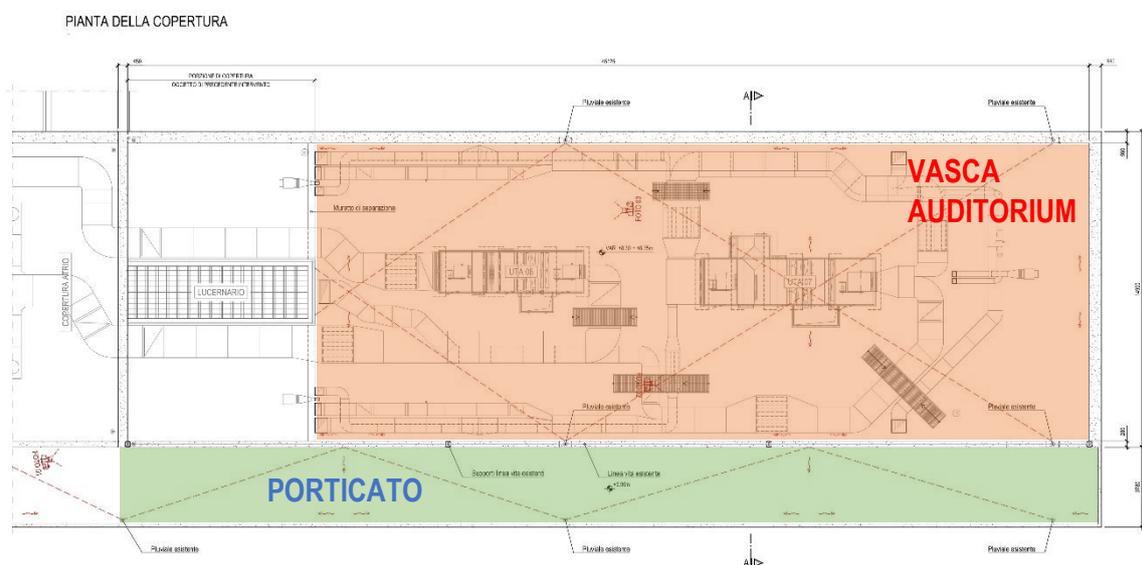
Planimetria con Ubicazione Porzione oggetto di Intervento retinata in colore arancione.
